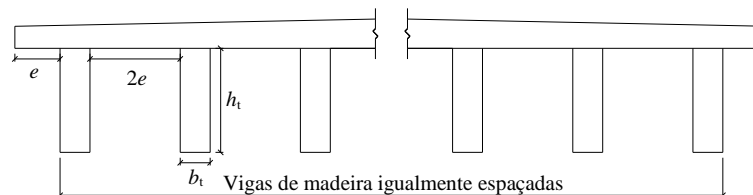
Secção transversal das vigas de madeira lamelada colada.
